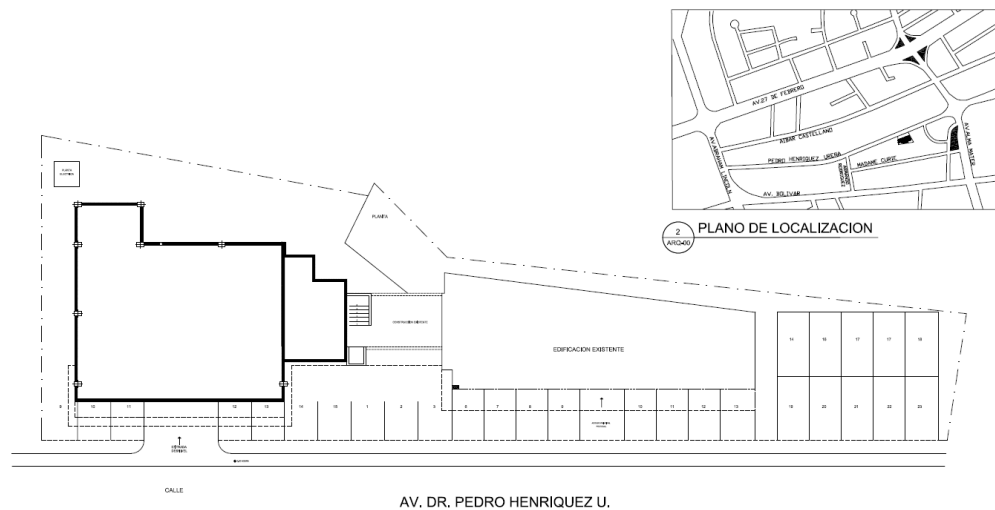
Planta de Conjunto Edificio Principal y Anexo Banco Ademi. (2006)
